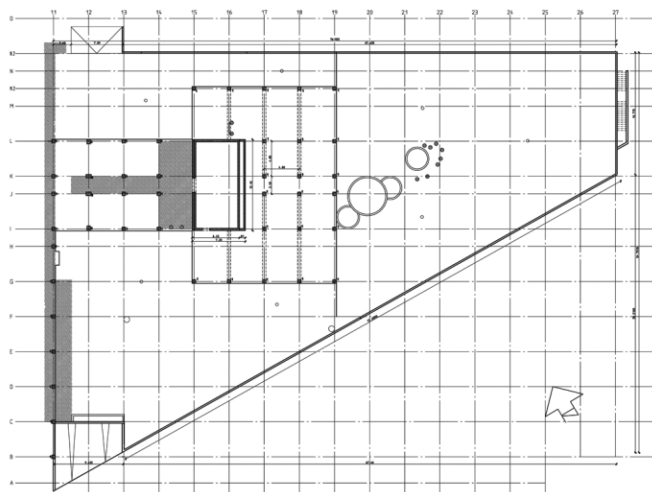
Grundriss der Tiefgarage (Ebene 0)
